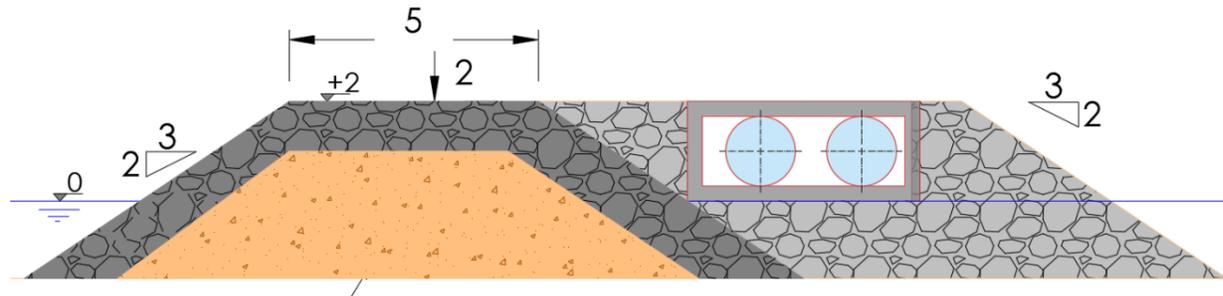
Posible sección a futuro para el encauzamiento de pluviales
